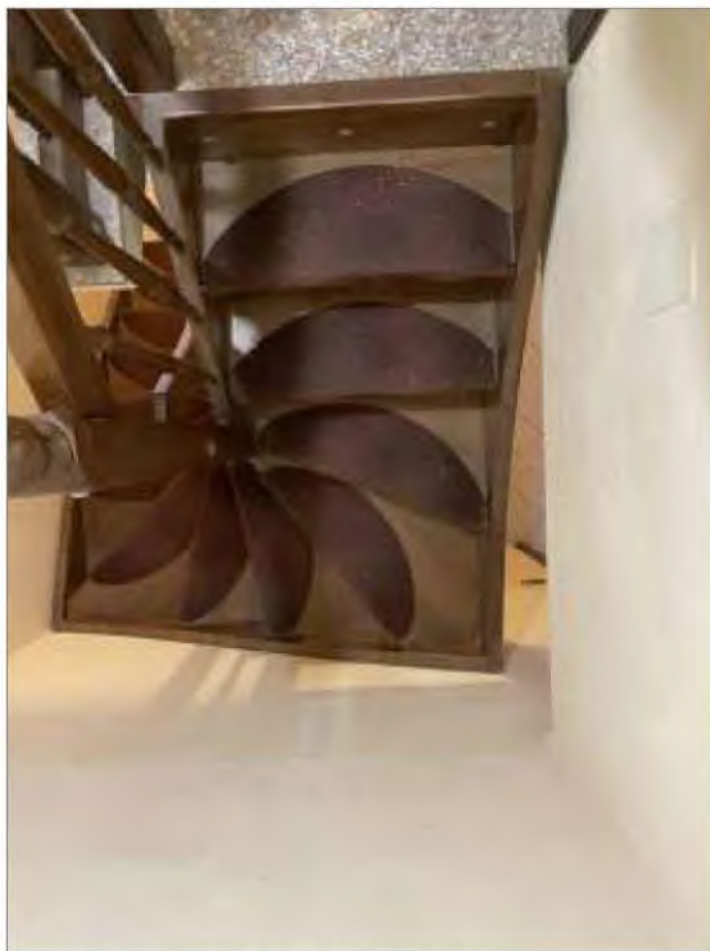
Scala a chiocciola di collegamento col piano 1°
